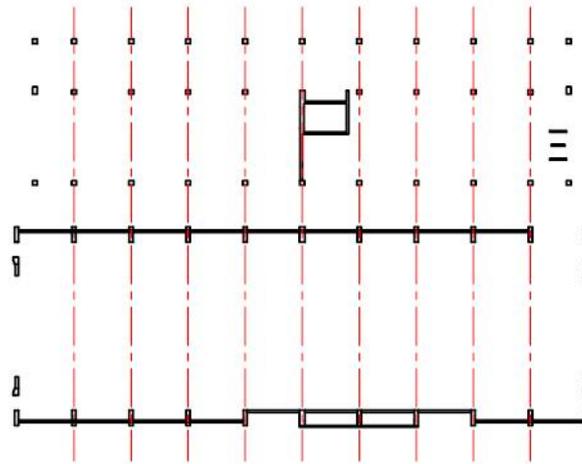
Plan FRAC - Alignement de la structure nouvelle sur l'existante
